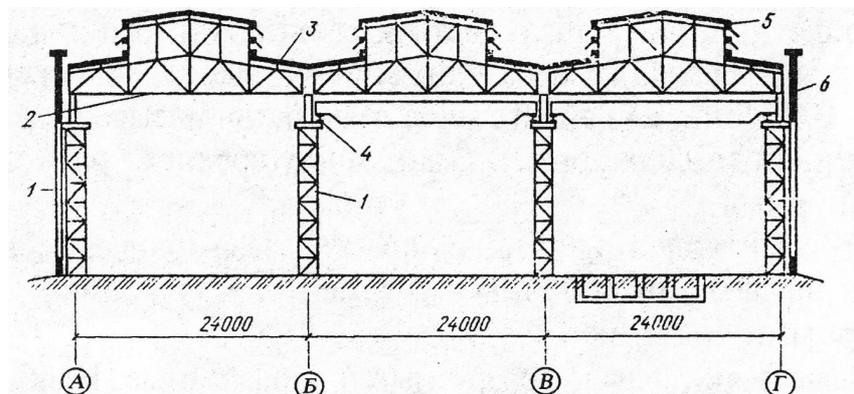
Разрез одноэтажного здания со стальным каркасом:
